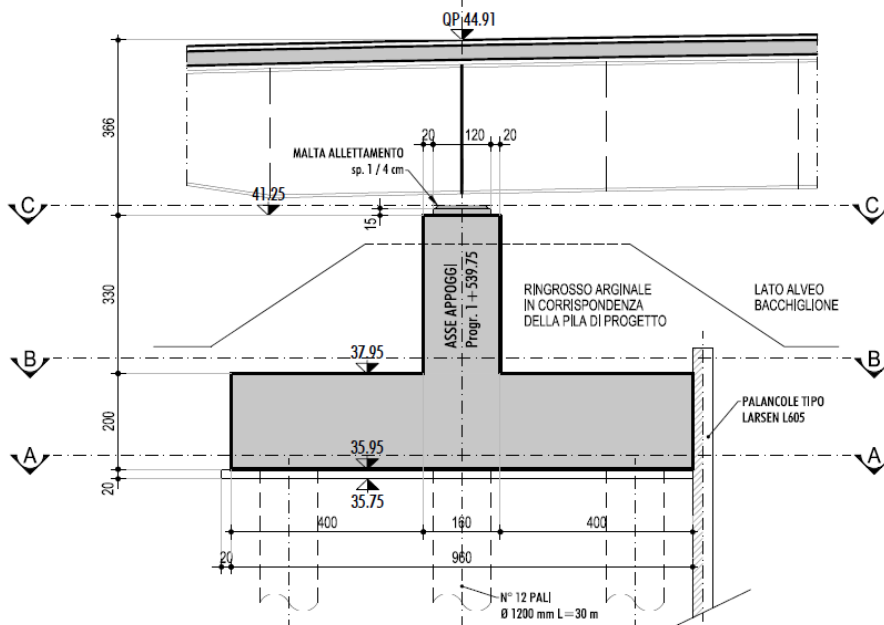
SEZIONE LONGITUDINALE PILA
